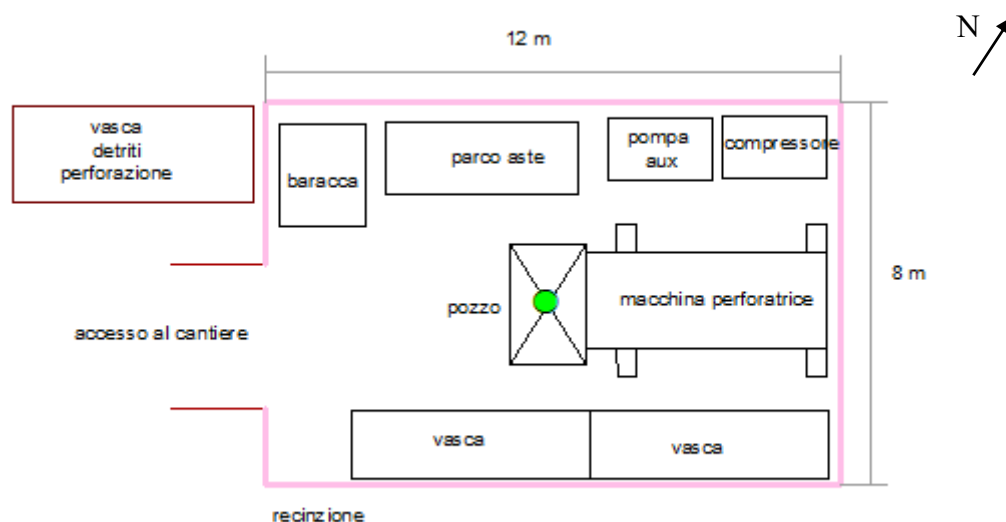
Layout di cantiere del pozzo 3 con i principali equipments (estratto da Allegato 1 – Tavola schema cantiere)
